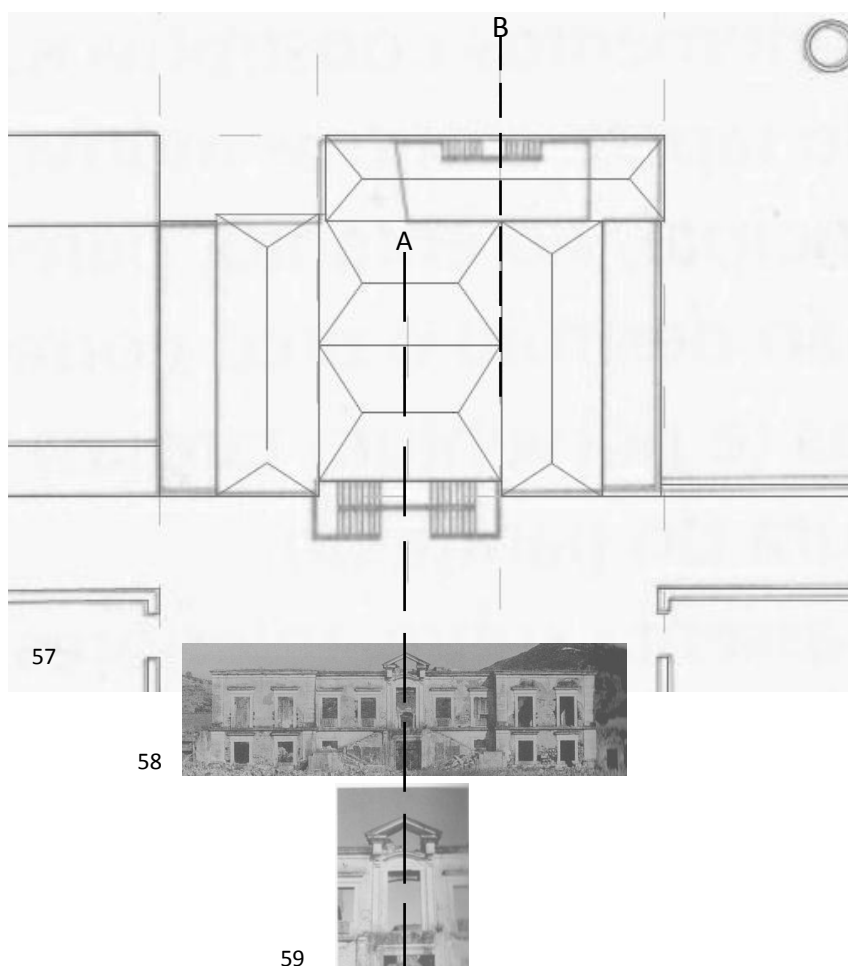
Planta do piso térreo da casa – relações simétricas (eixo A), proporções (a cinza) e construções anteriores (a preto), fonte: desenho da autora.
